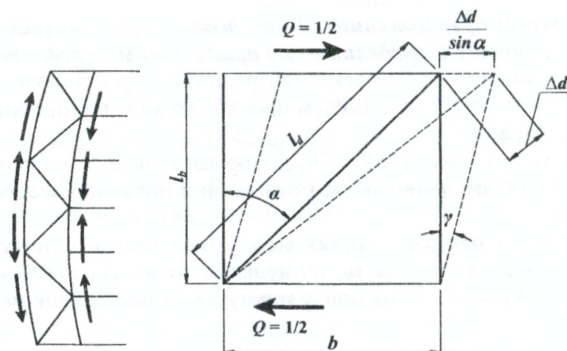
Перекос раскосной решетки при продольном изгибе стержня
